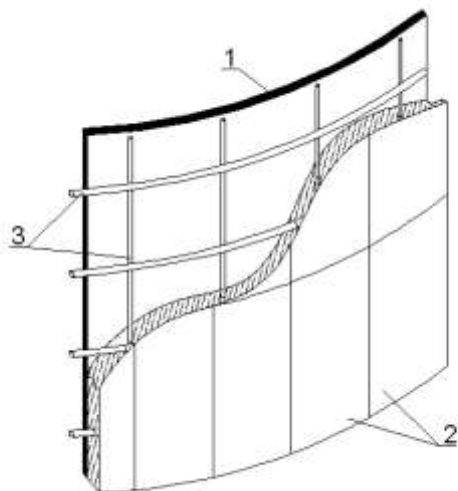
Фрагмент стенки резервуара из сборных железобетонных блоков
